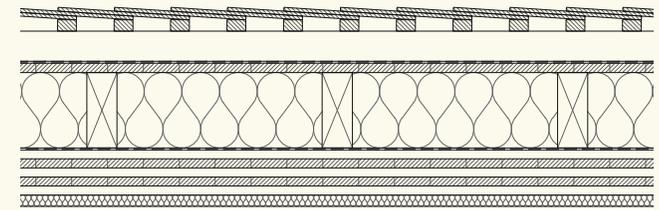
, technischer Aufbau eines geneigten Daches | 1:20
